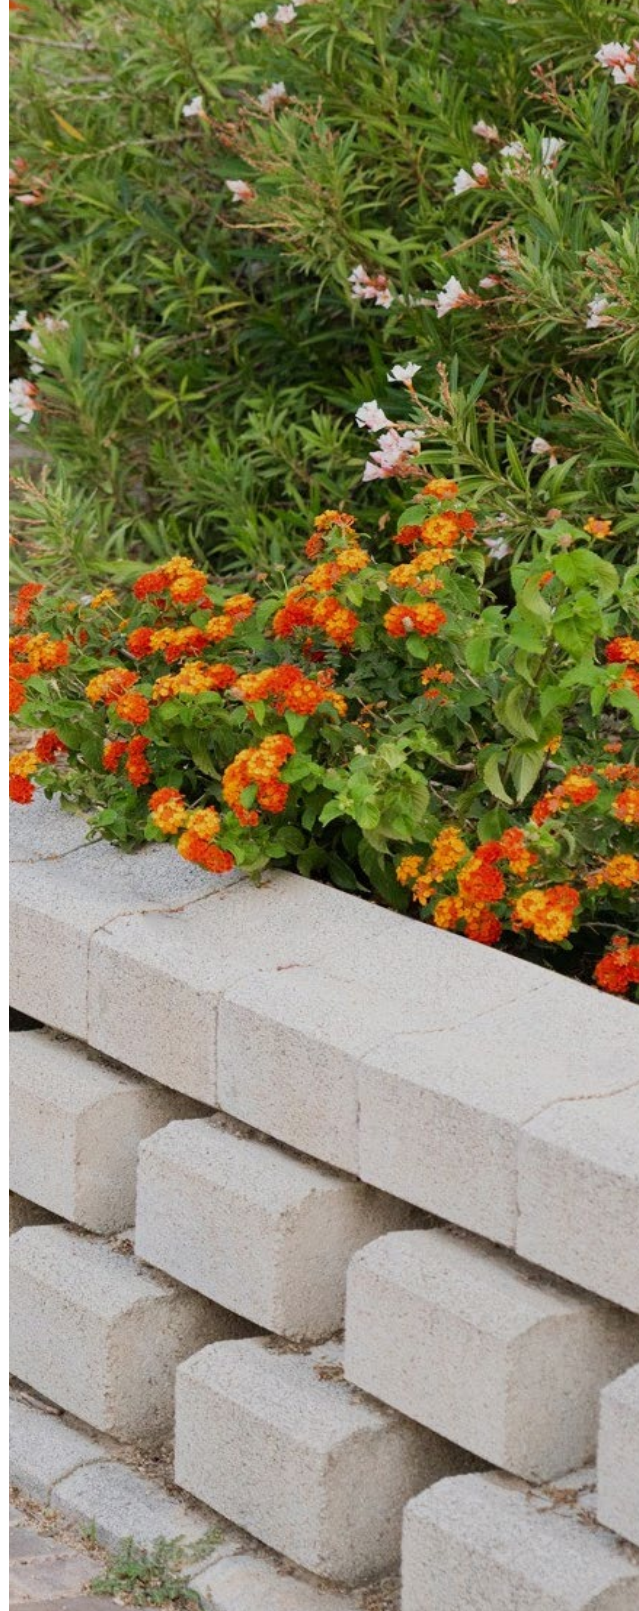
| Fotografía de Muro Ribazo en el Hospital radioterapia en San Juan (Alicante).
